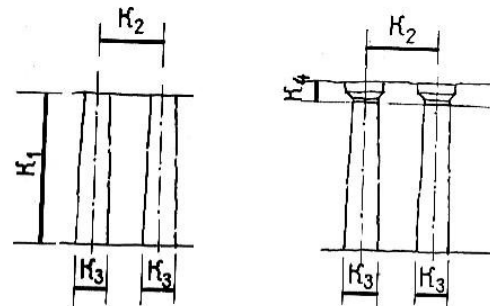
Схема побудови фасаду Парфенона (по Хембіджу)
